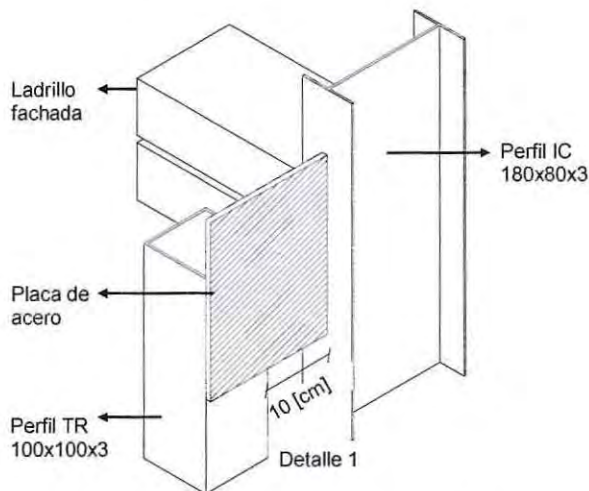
Esquema conexión de placa de refuerzo con pilar de fachada.
